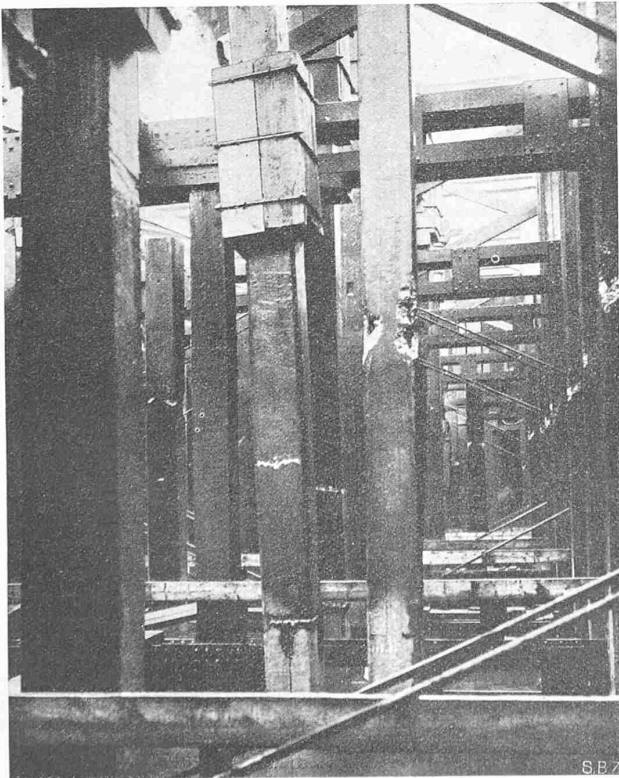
Beton-Pfähle der Pfeiler-Fundation.
